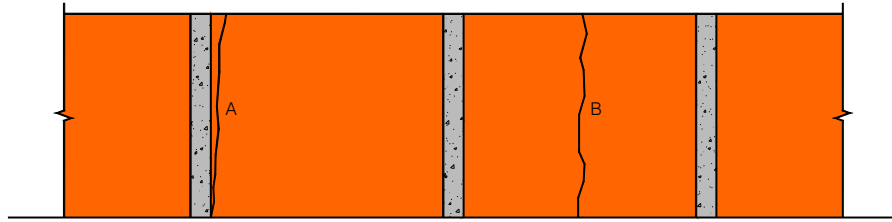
Fissuras verticais causadas por movimentações térmicas: a) destacamento entre alvenaria e pilar, b) fissura no corpo da alvenaria [30]
